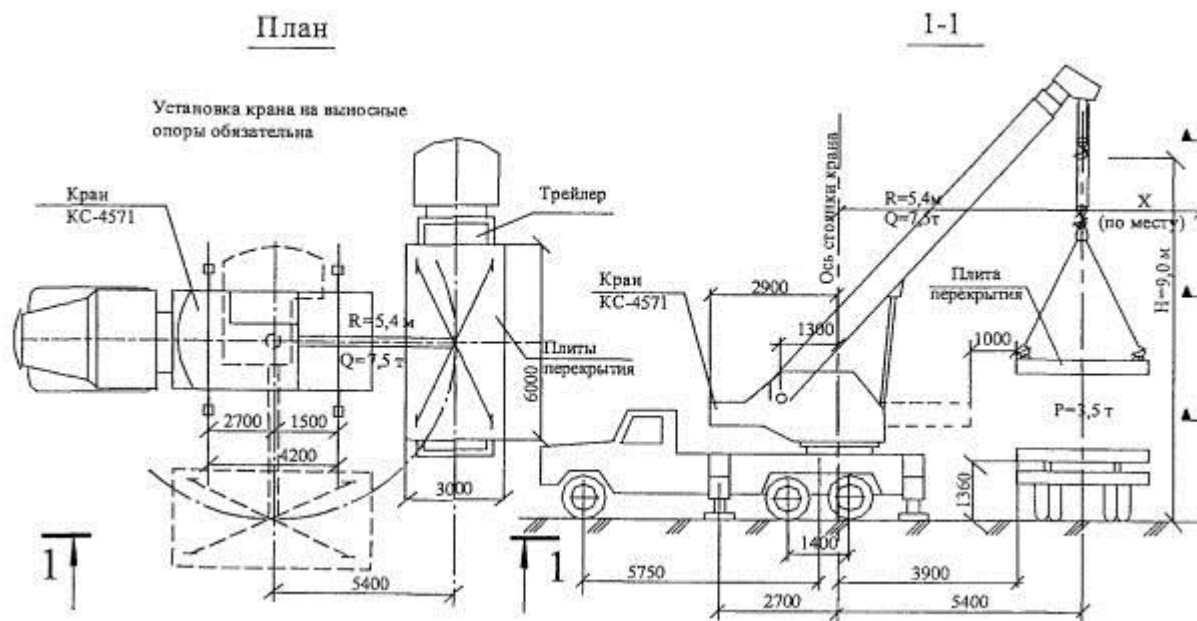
Погрузка и разгрузка плит перекрытий краном КС-4571
